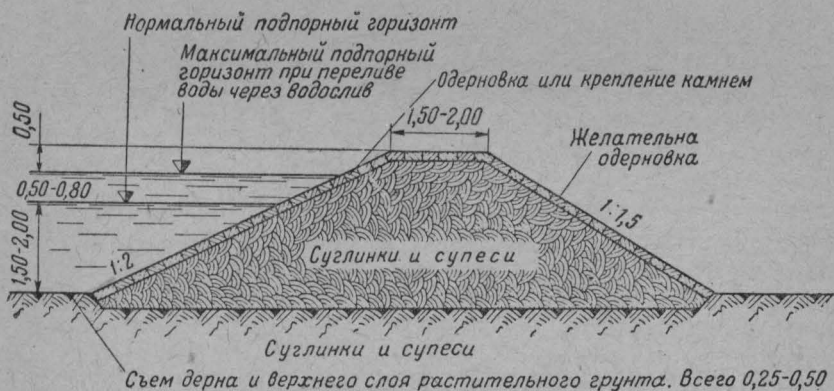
Поперечное сечение земляной плотины из однородного не фильтрующего или слабо фильтрующего грунта
